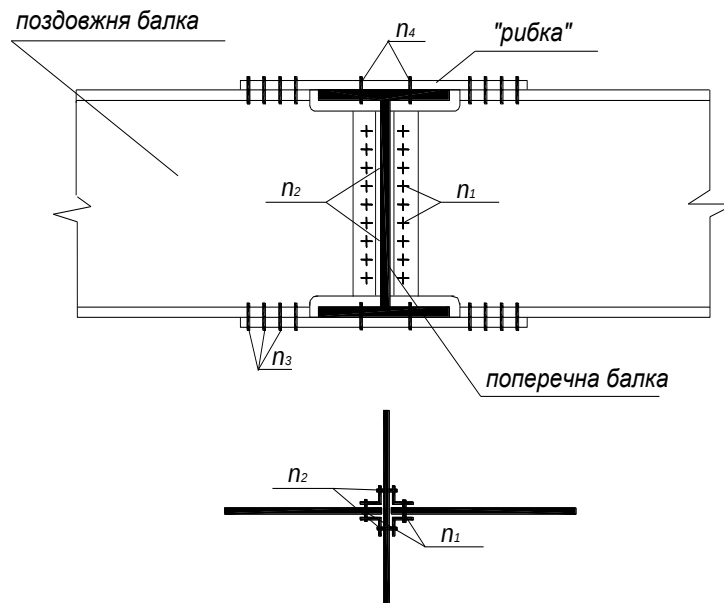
Прикріплення поздовжньої балки до поперечної
